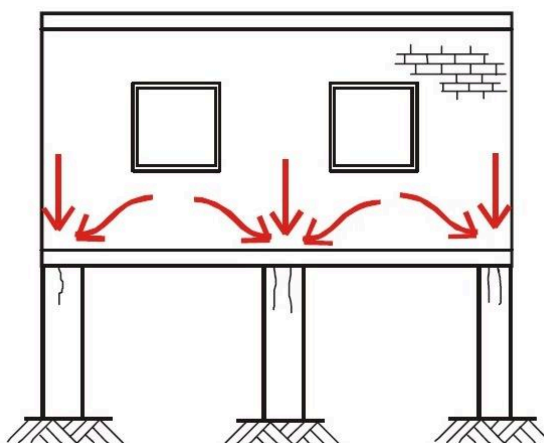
Fissuras verticais por sobrecargas em pilares de alvenaria (DUARTE, 1998)
